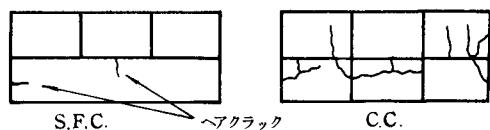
1年1ヶ月経過後の舗装Aのひび割れ発生状況
